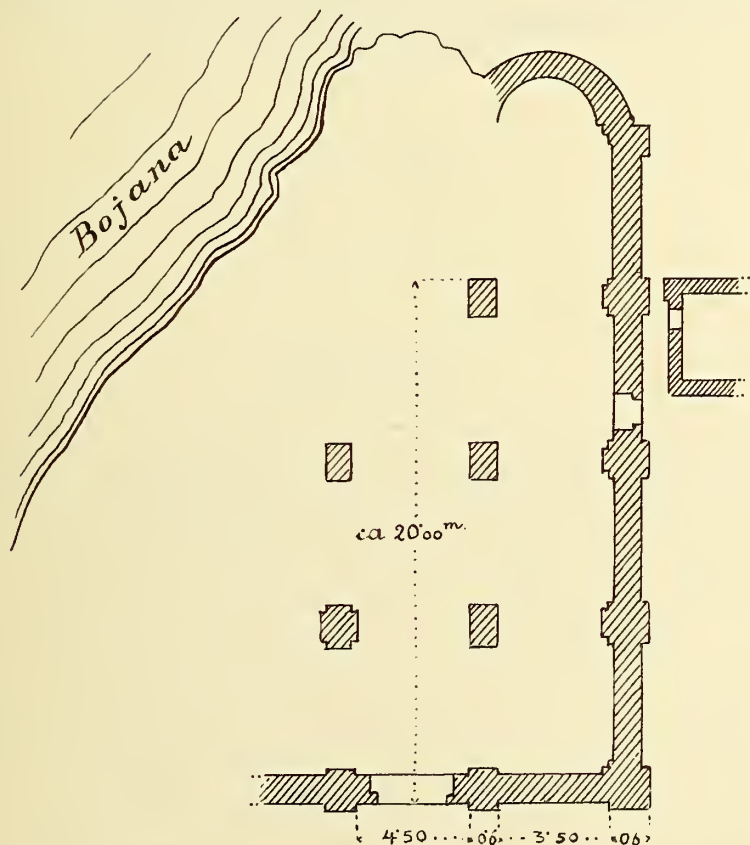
Grundriss der Kirchenruine von Širdži.
